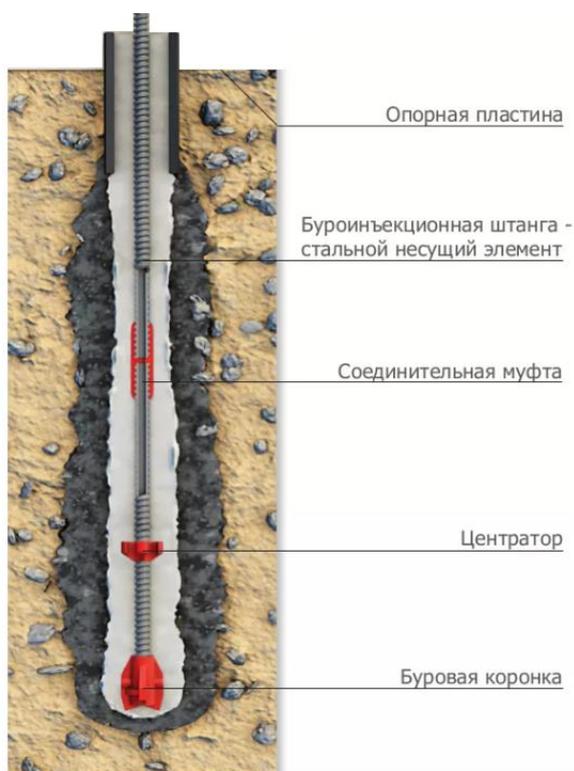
Конструкция буроинъекционной сваи типа Титан
